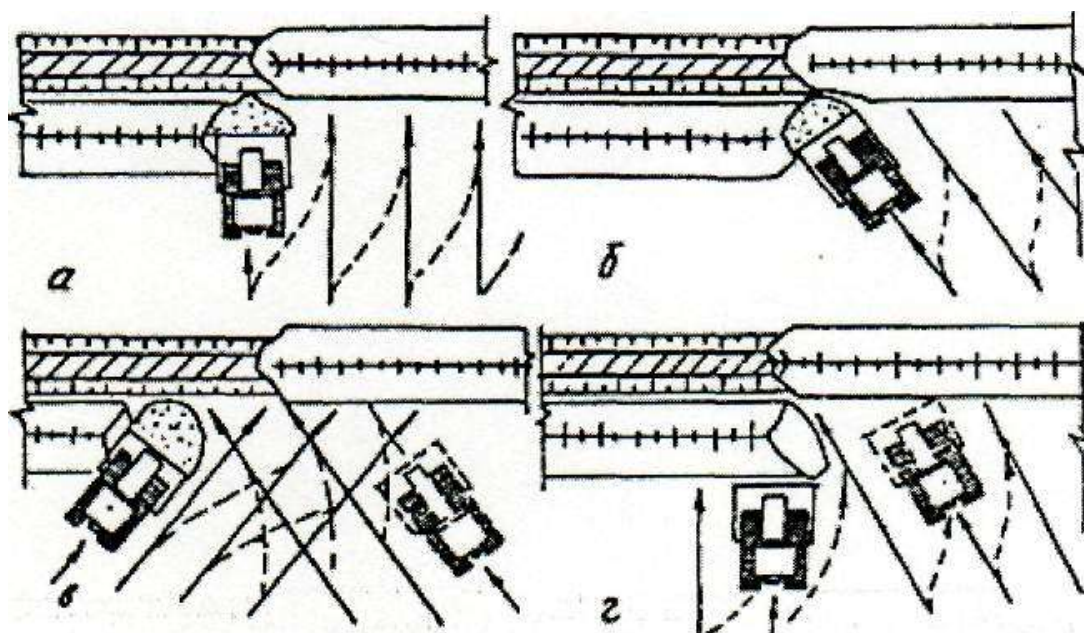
Схемы производства работ по засыпке амбара бульдозером:
